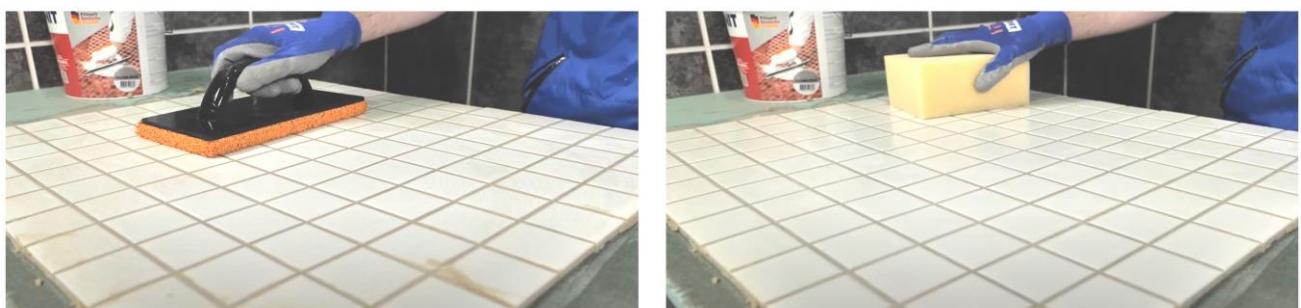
Диагональными движениями шпателя убрать с поверхности плитки излишки затирки
